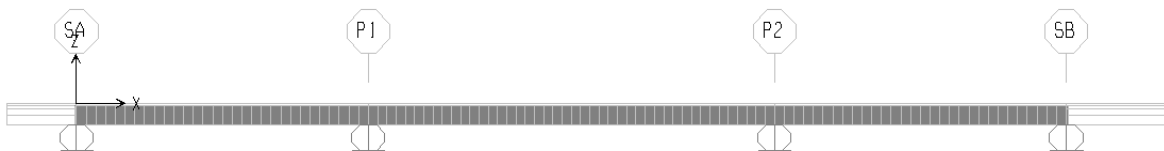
Sezione longitudinale schematica impalcato (Spalla SA lato Verona, spalla SB Mantova)
